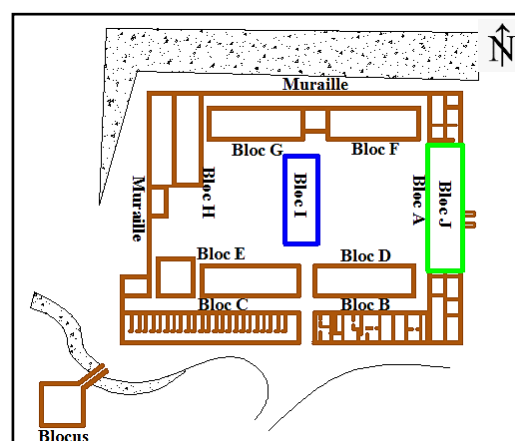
Plan du projet de Sanatorium. Source : Auteurs
